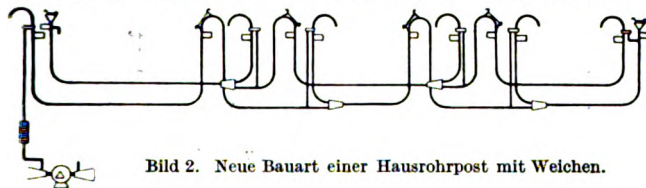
Neue Bauart einer Hausrohrpost mit Weichen.
